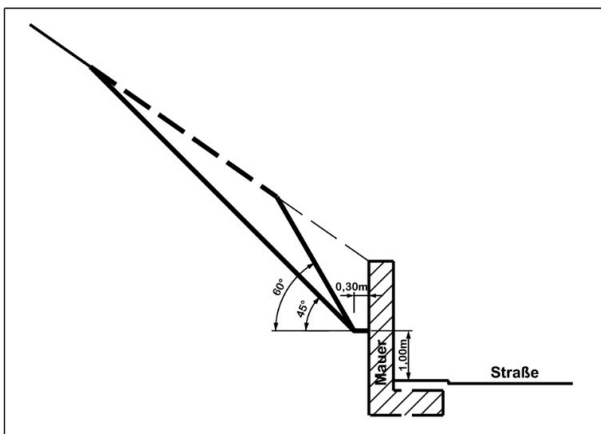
Baugrube Teilaushub mit 45°- und 60°-Neigung
